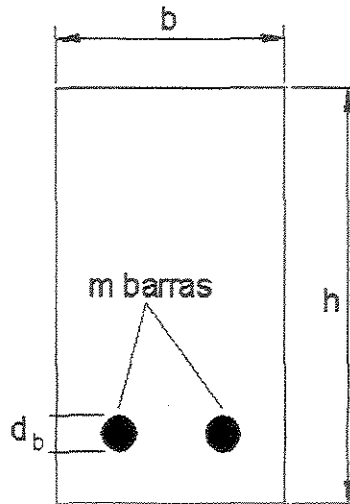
Seção transversal de um elemento de concreto armado.
